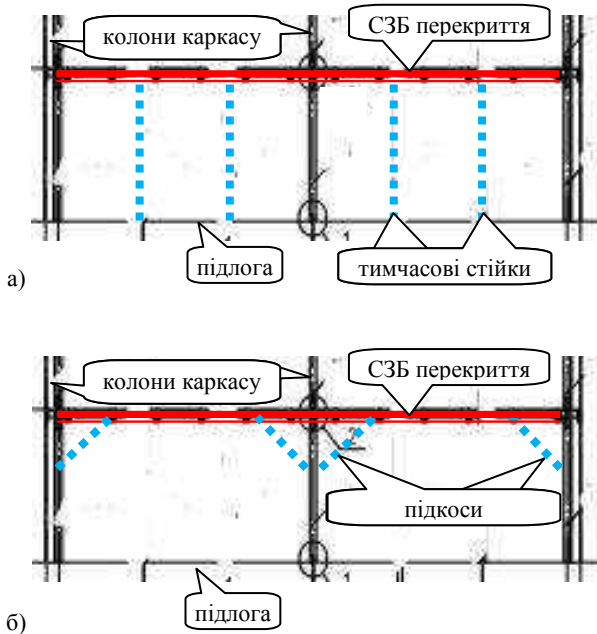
Схеми додаткових опор під сталеві балки сталезалізобетонного перекриття: а) встановлення стійок до нижче розташованого перекриття чи підлоги; б) встановлення підкосів до колон
